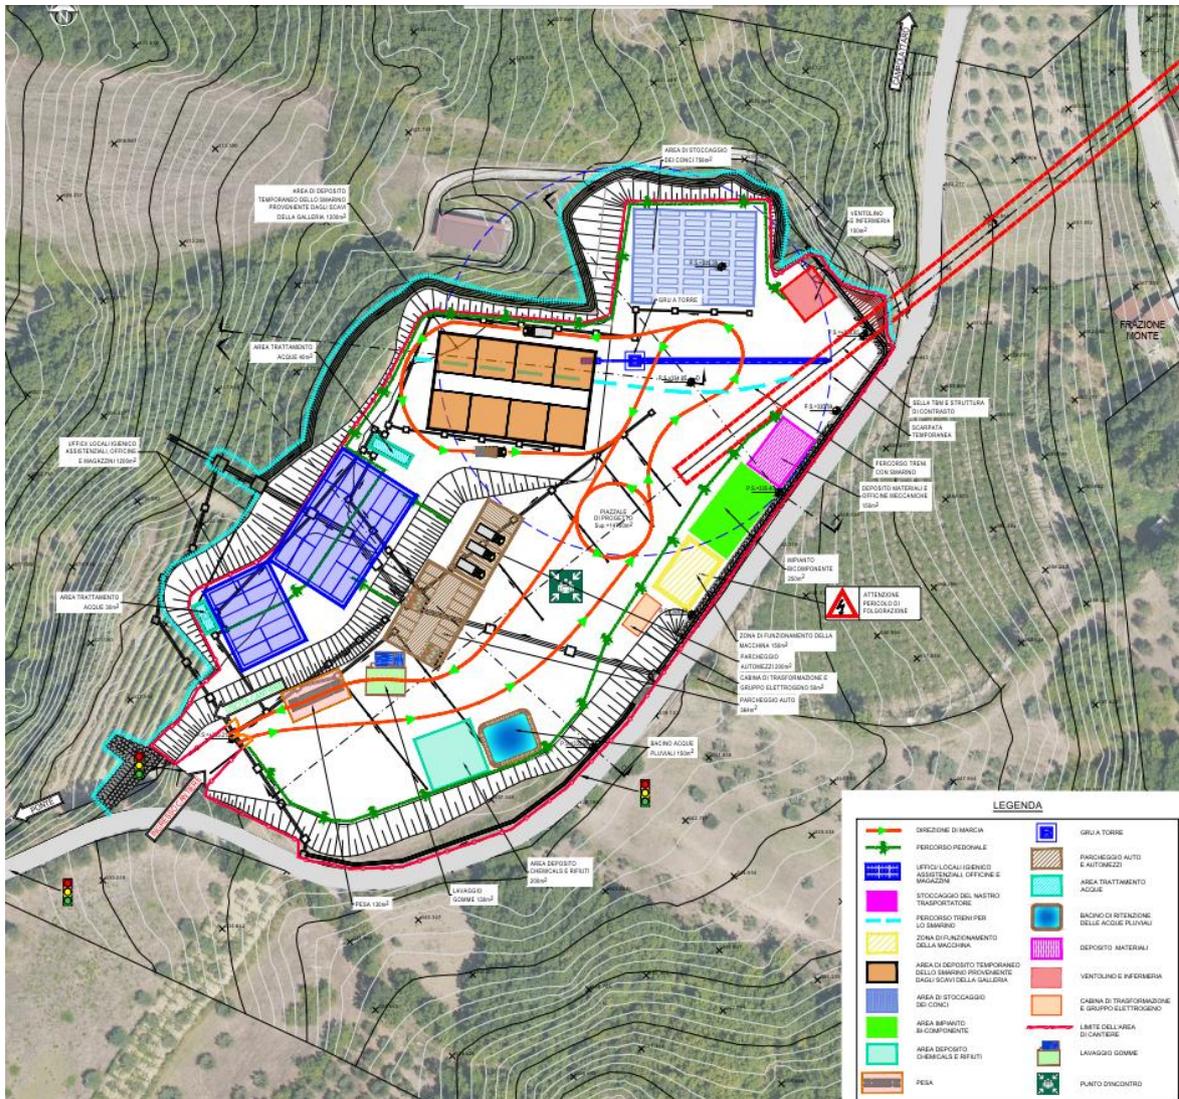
Cantierizzazione del piazzale all’imbocco della galleria di derivazione
